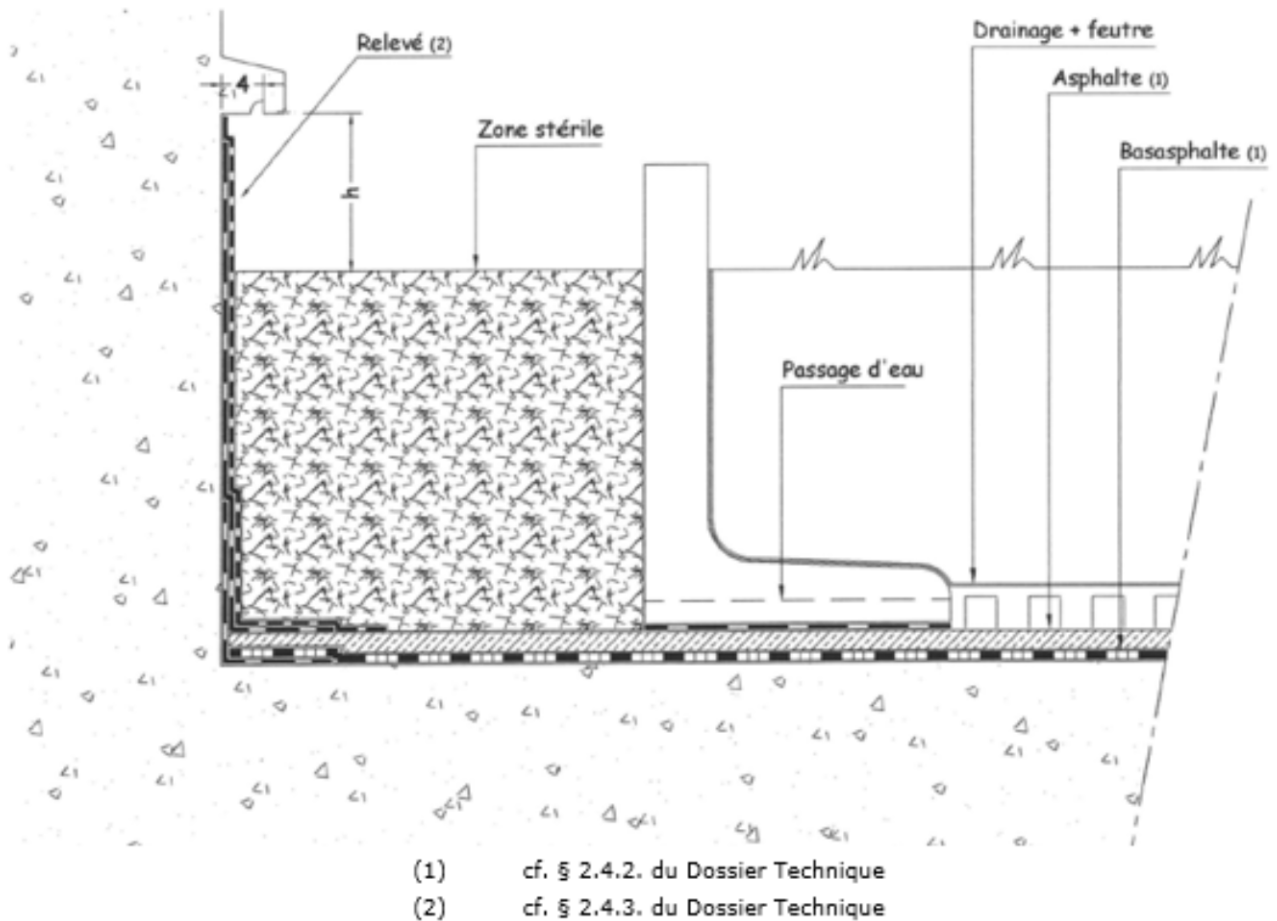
Coupe sur relevés en toiture-terrasse jardin
